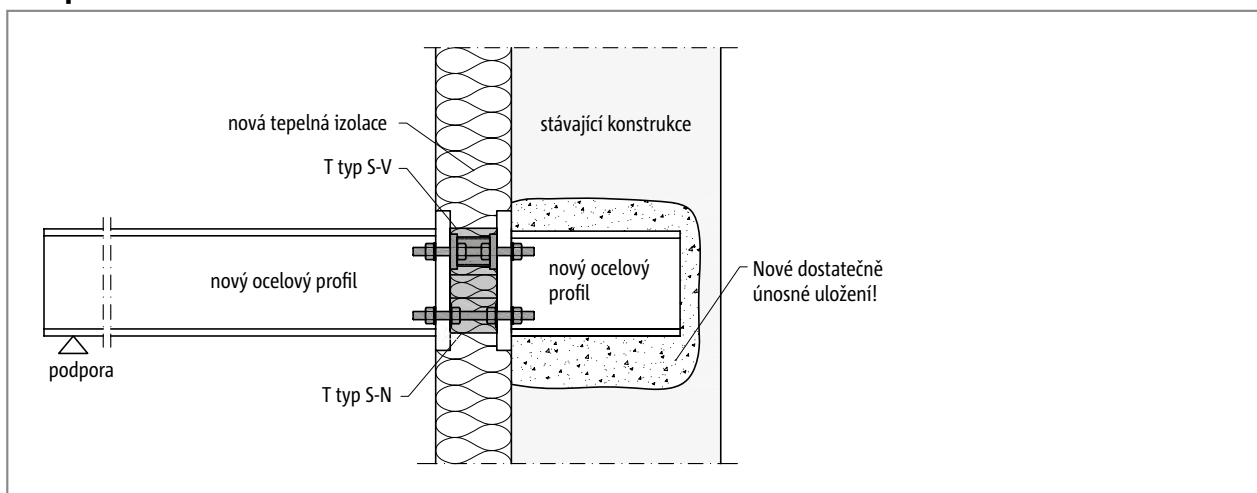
Schöck Isokorb® T typ S-N a T typ S-V: Dodatečně provedený volně vyložený prefabrikovaný balkón; napojení na dodatečně zabudovaný ocelový nosník; sešroubování uvnitř
